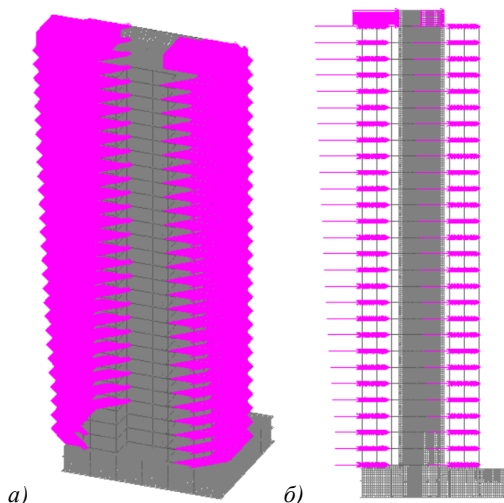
Ветровая нагрузка: *a* – на боковую сторону здания; *б* – на фронт здания
